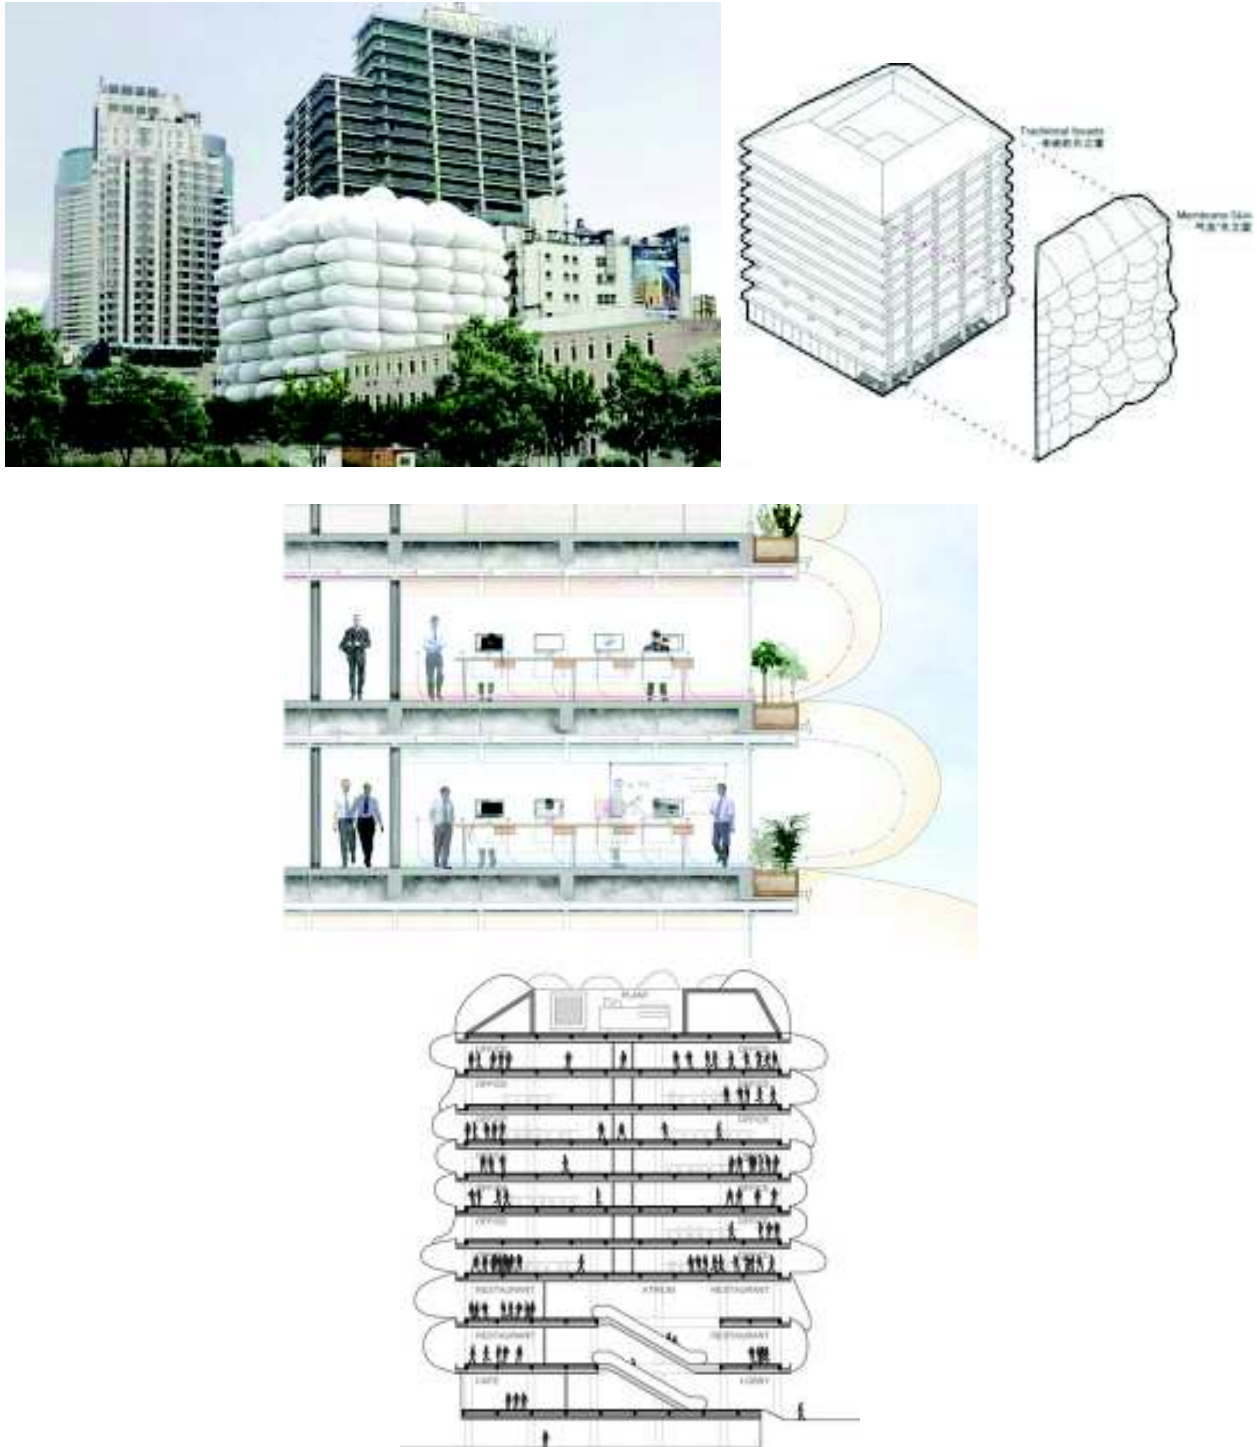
Proiectul Bubble Building, Shanghai [100]
